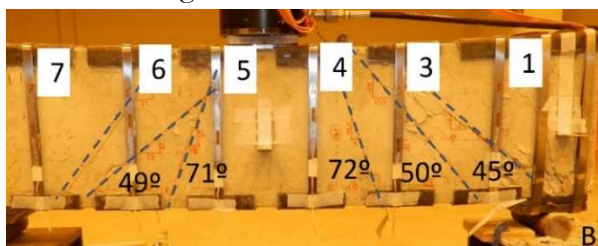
Fisuración diagonal en rotura y nomenclatura de las bandas. Viga TG-T-N-20P/B
